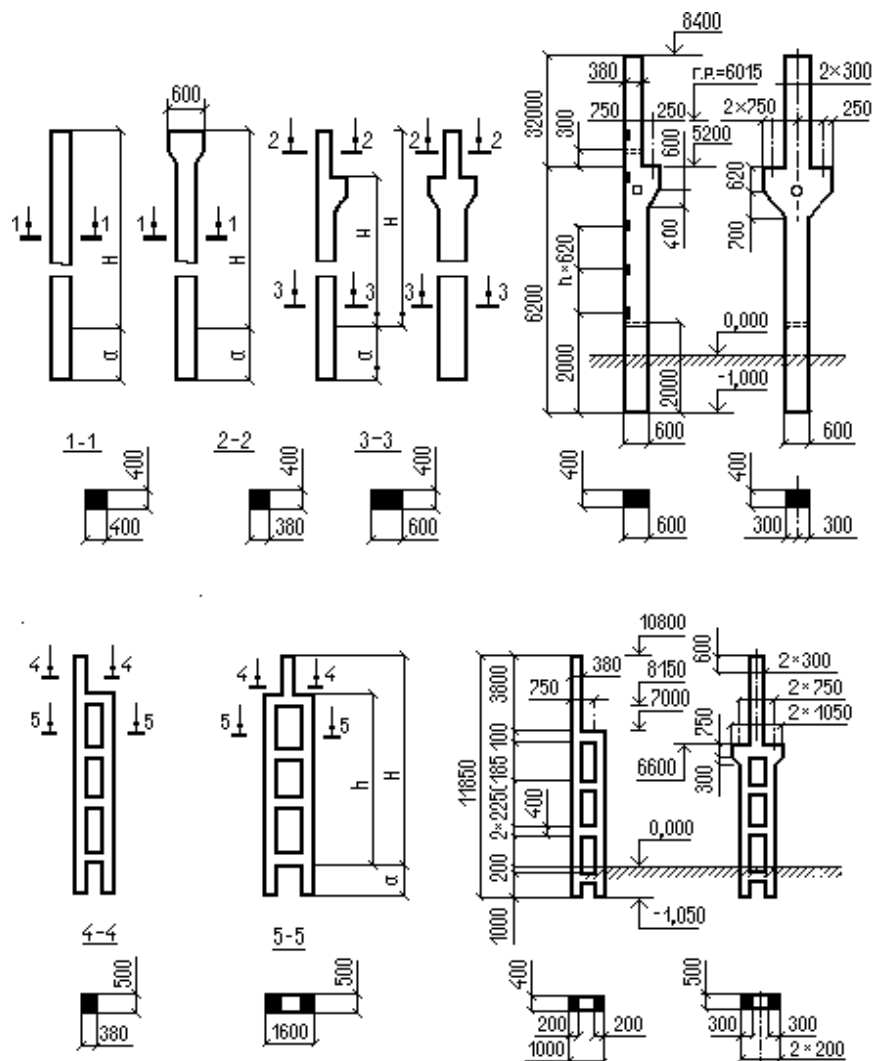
Конструкции железобетонных колонн одноэтажных производственных зданий.
